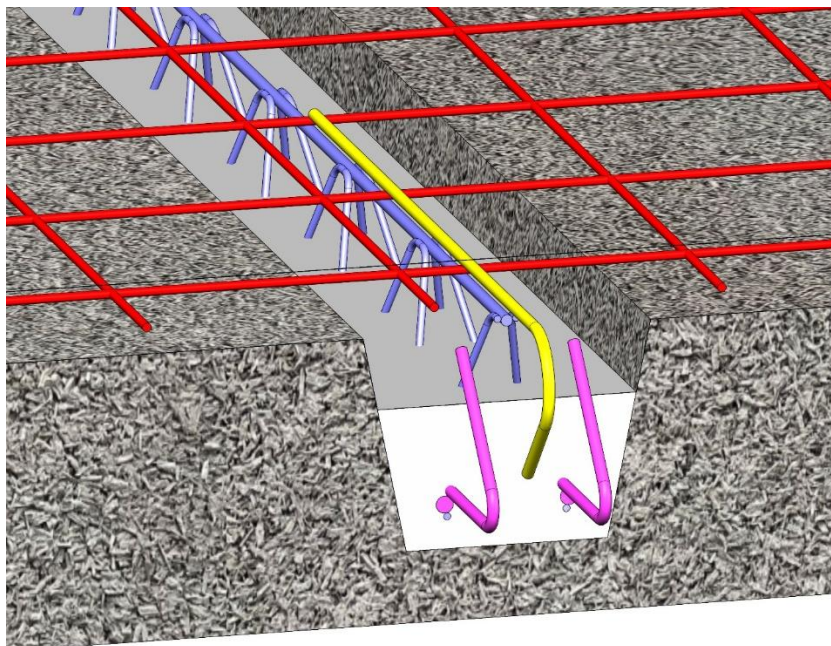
Positionnement des aciers de flexion supérieure ou chapeaux sur les treillis soudés
